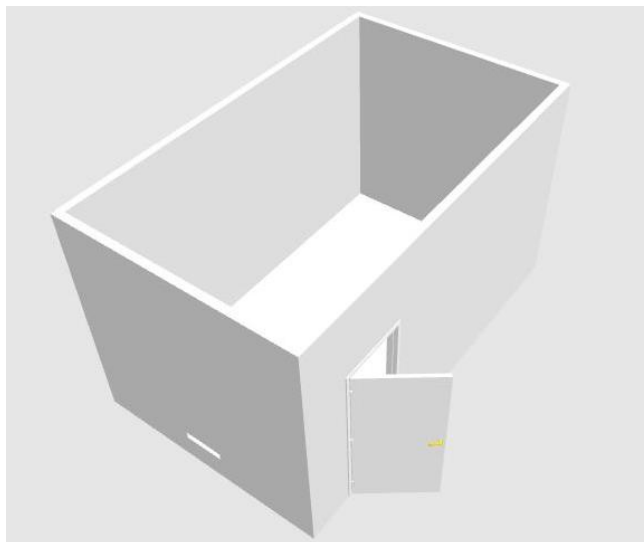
vista 3D de la cámara, con puerta y entry port de cables
